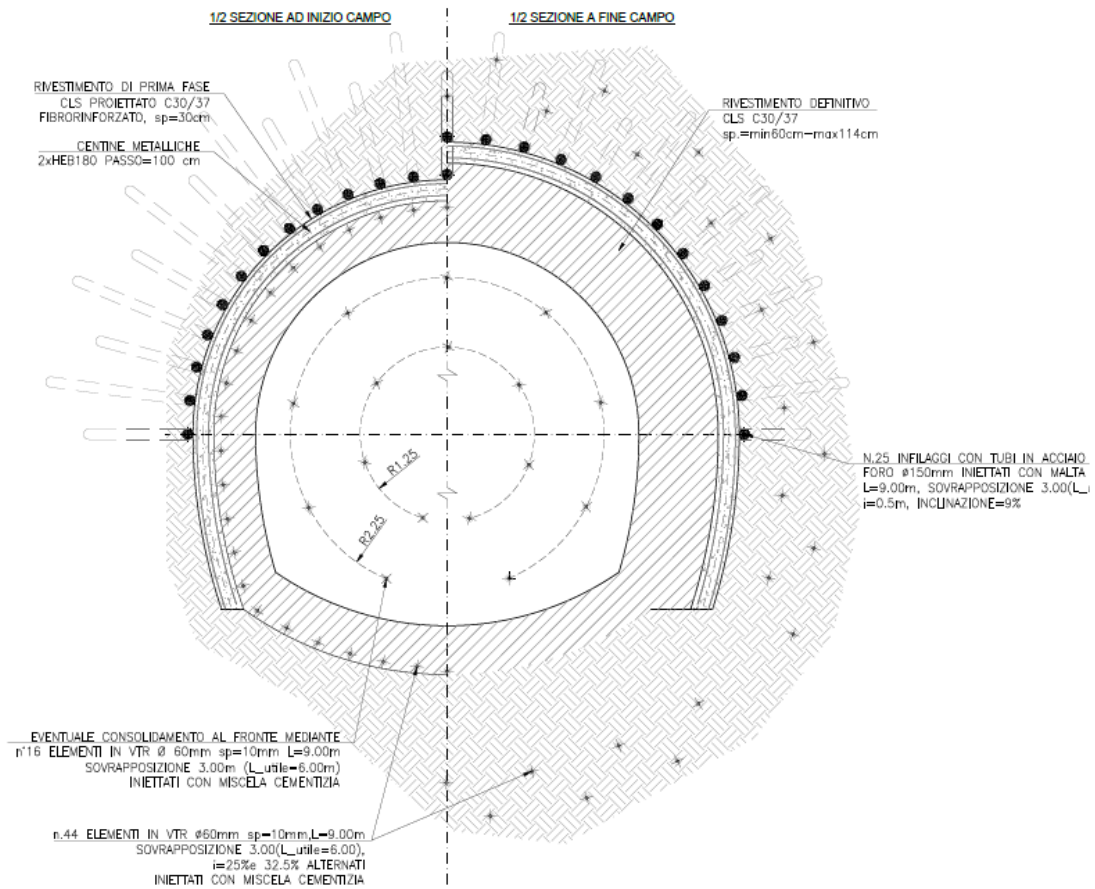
Sezione tipo GI-5: geometria del cavo e interventi di sostegno, sezione trasversale
